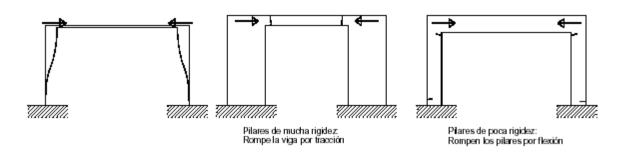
Fisuras de retracción en vigas y columnas (pilares)
